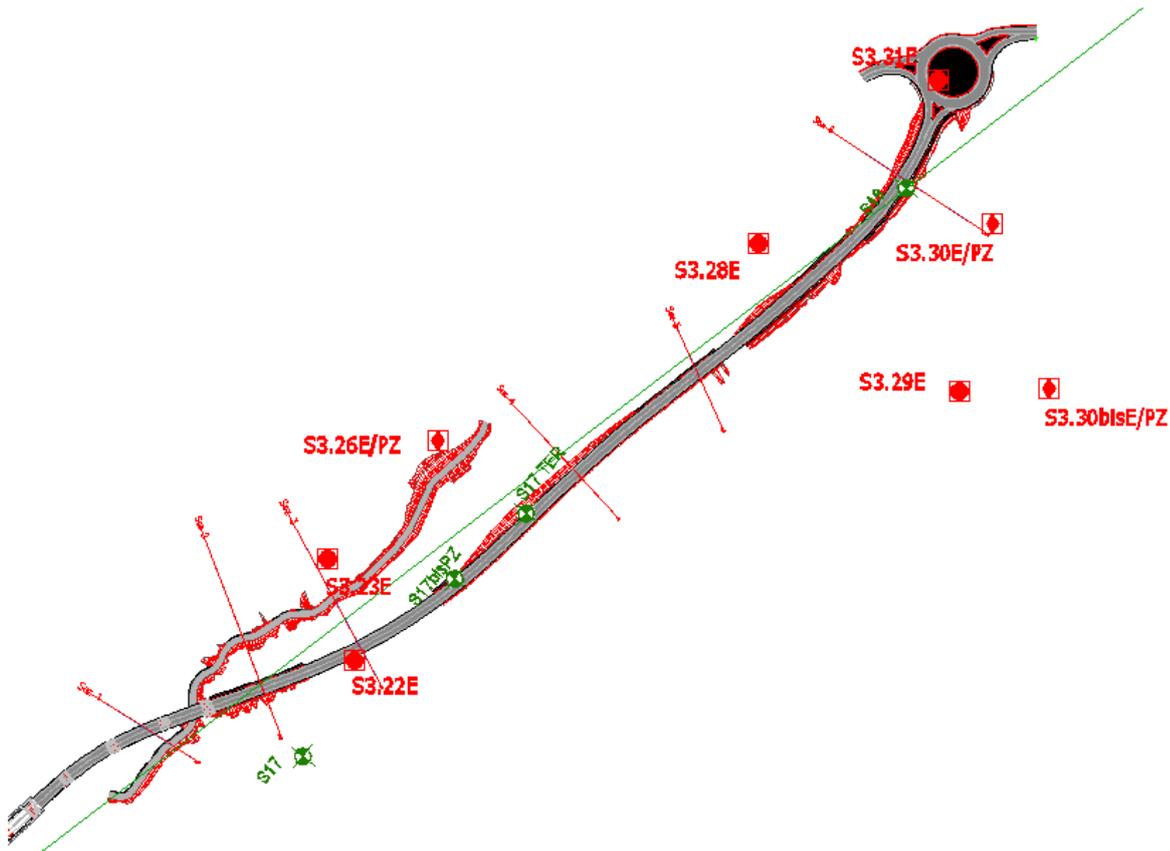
Planimetria con indicazione delle sezioni di calcolo.
